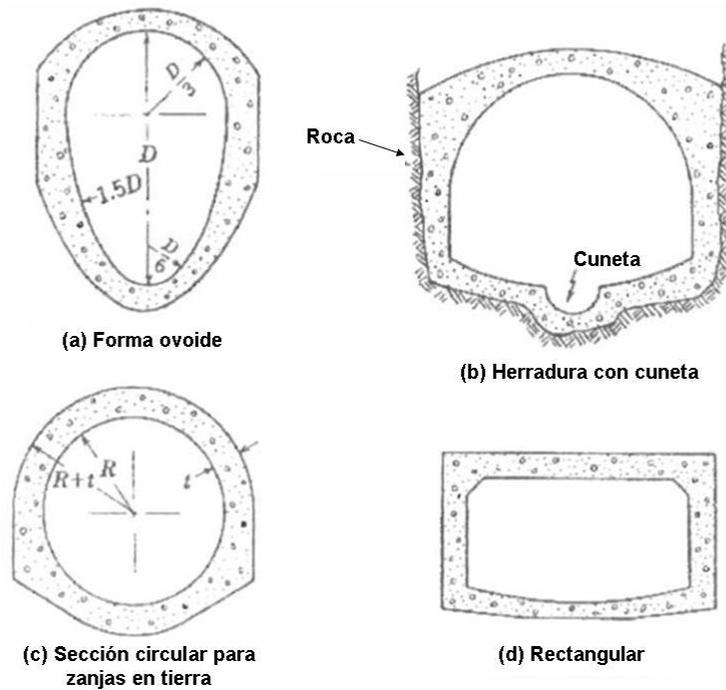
ALGUNAS SECCIONES DE CONDUCTOS DE ALCANTARILLADO COLADAS EN LA OBRA.
